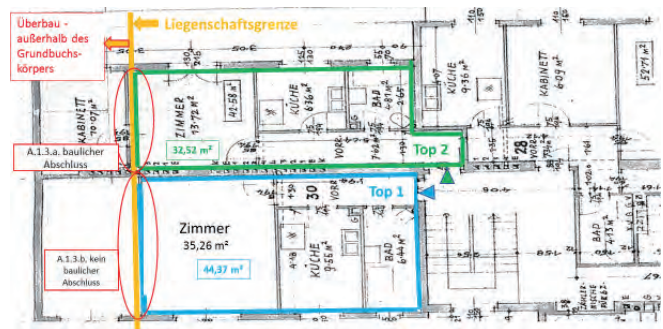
Grundriss mit den überragenden Bauteilen; mit (siehe Markierung A.1.3.a) und ohne (siehe Markierung A.1.3.b) baulichen Abschluss (die überragenden Bauteile sind als Überbauten zu verstehen, da sie vom Boden weg bebaut sind)
